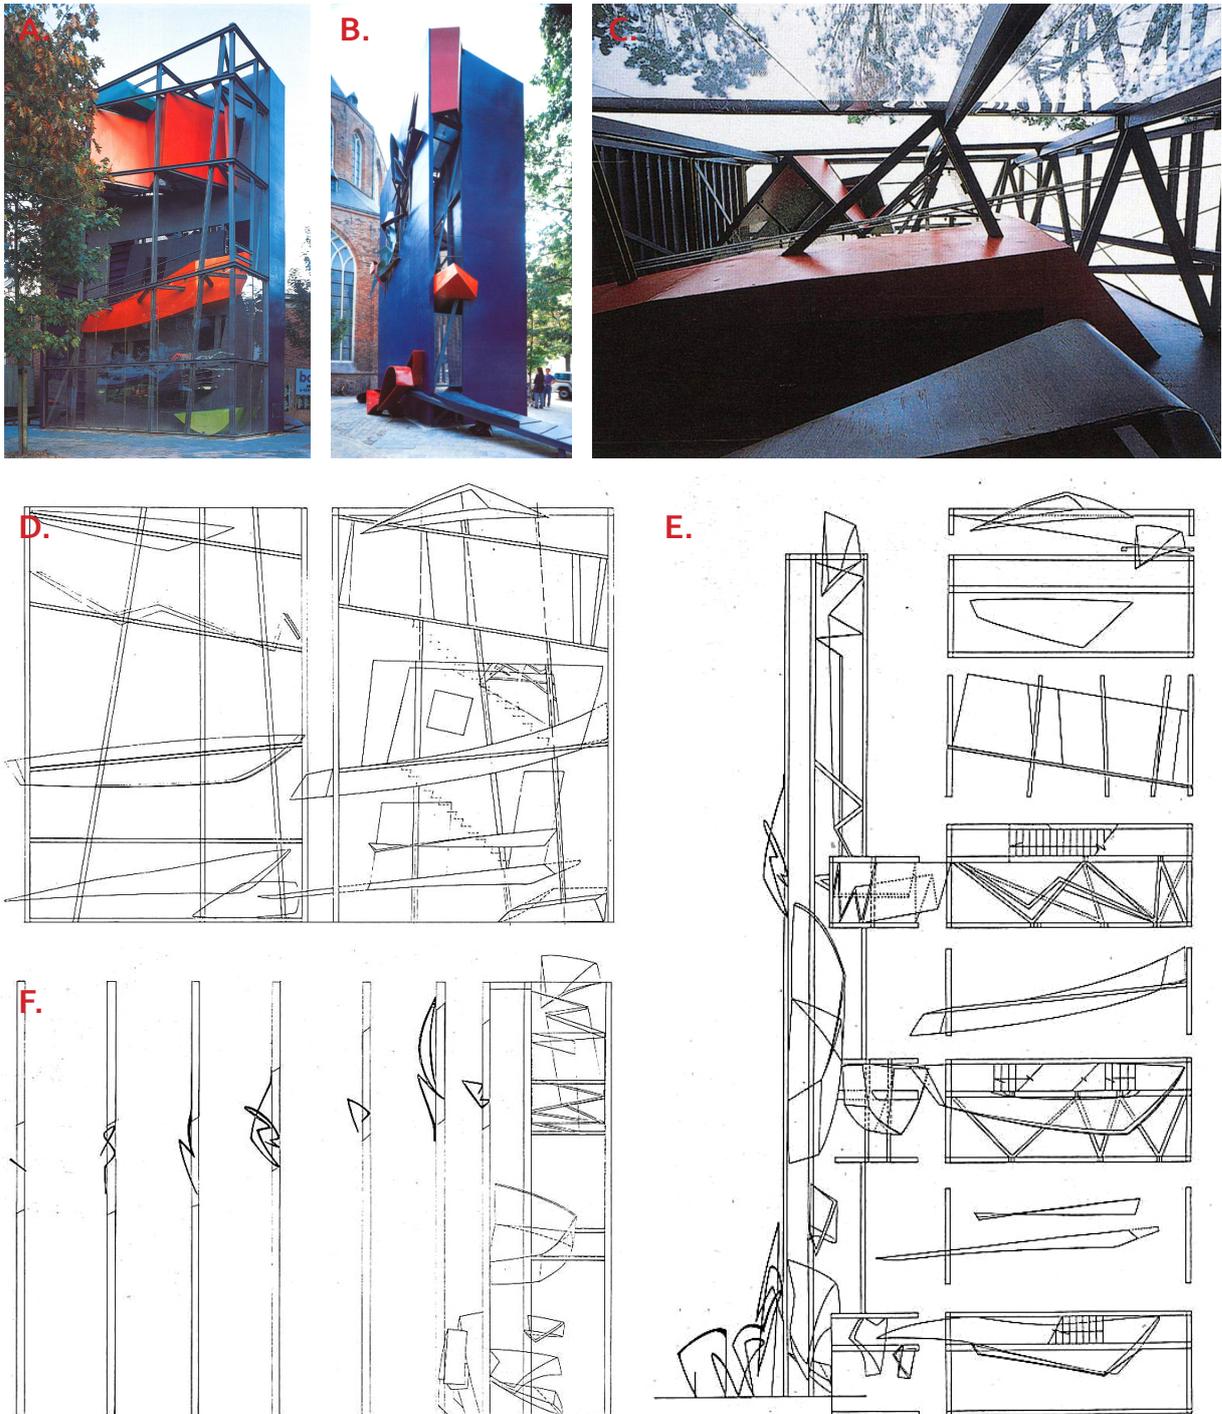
A. B. C. Music Video Pavillion, detalle de fachadas. (Hidden Architecture, 2016). D. E. F. Planimetrías Music Video Pavillion de Zaha Hadid. Secciones fachada posterior, sección transversal y alzado frontal y sección longitudinal. (Hidden Architecture, 2016).
